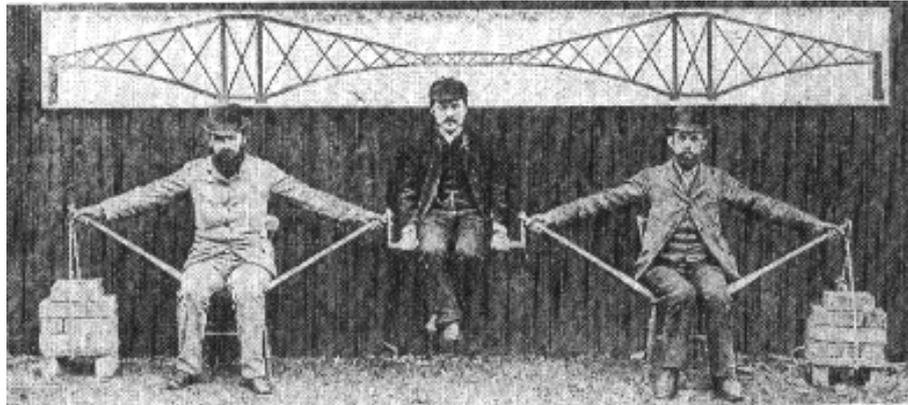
Demonstração empírica do sistema estrutural da ponte Firth of Forth
